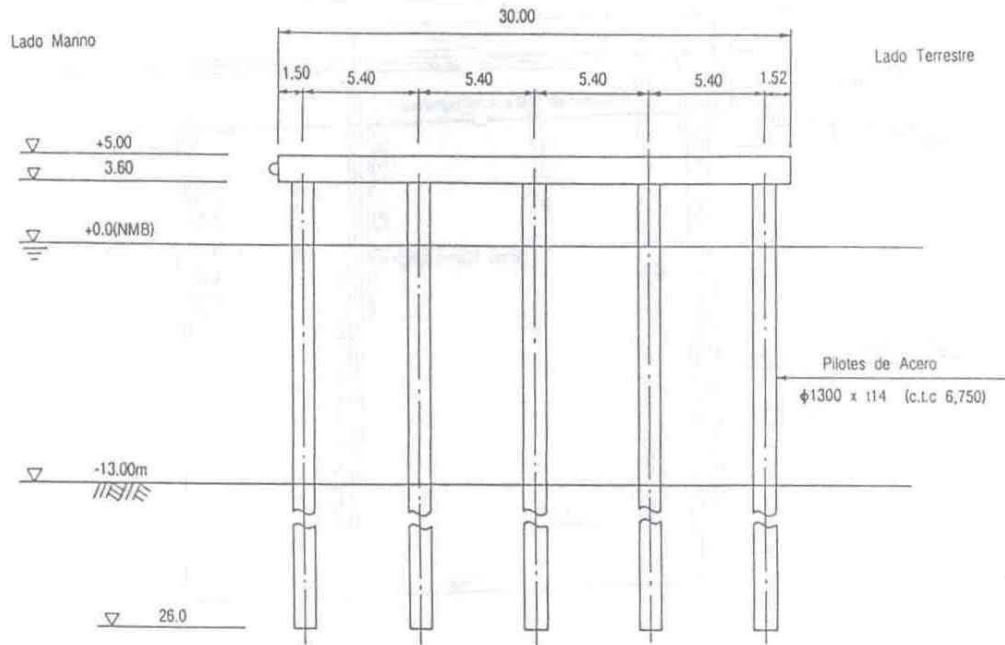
Sección Típica Atracadero Contenedores -13 m
